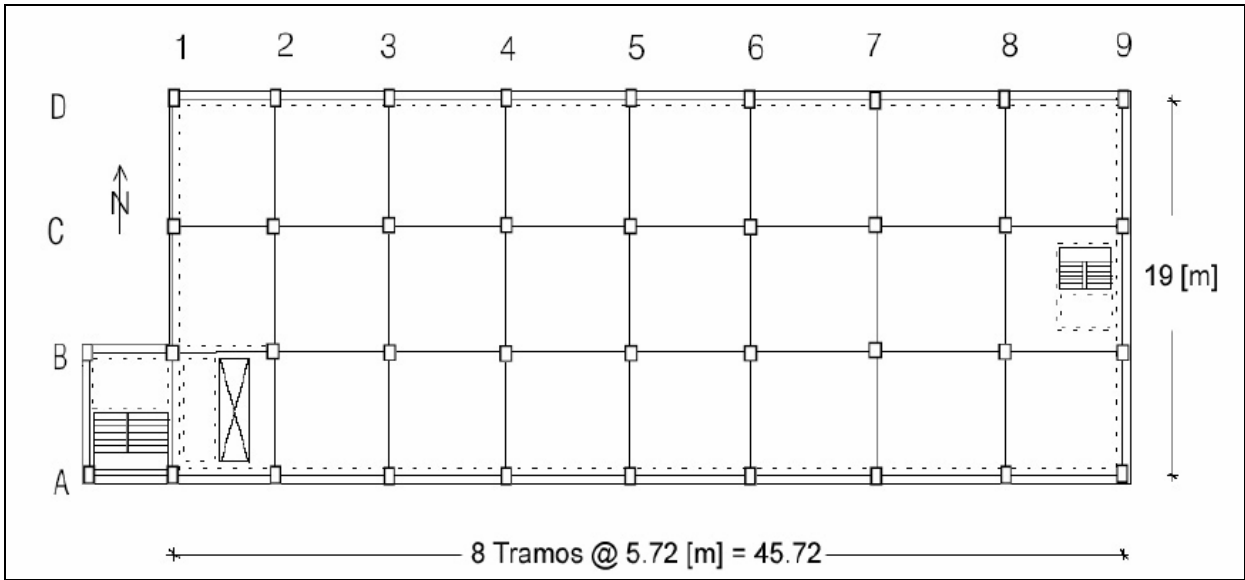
Planta piso tipo edificio Hotel Holiday Inn. (Trifunac y Hao, 2001)
